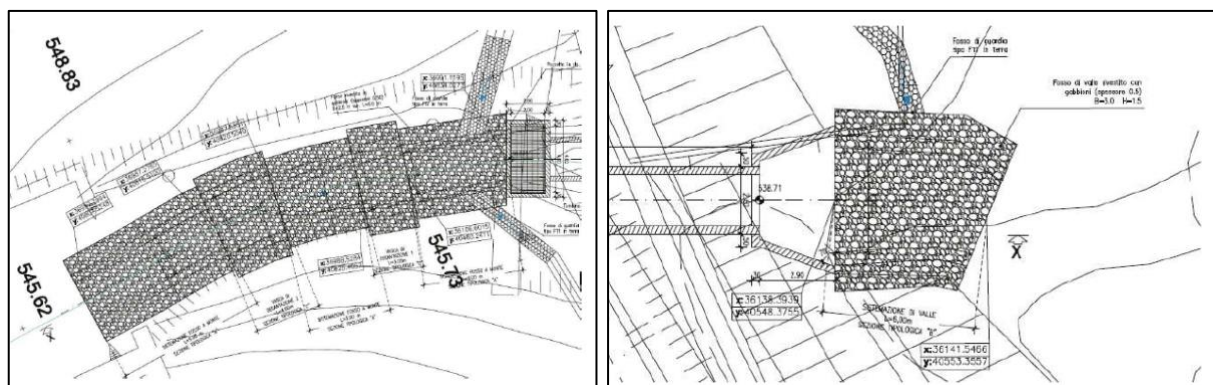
Stralcio planimetrico inalveazione a monte e a valle
